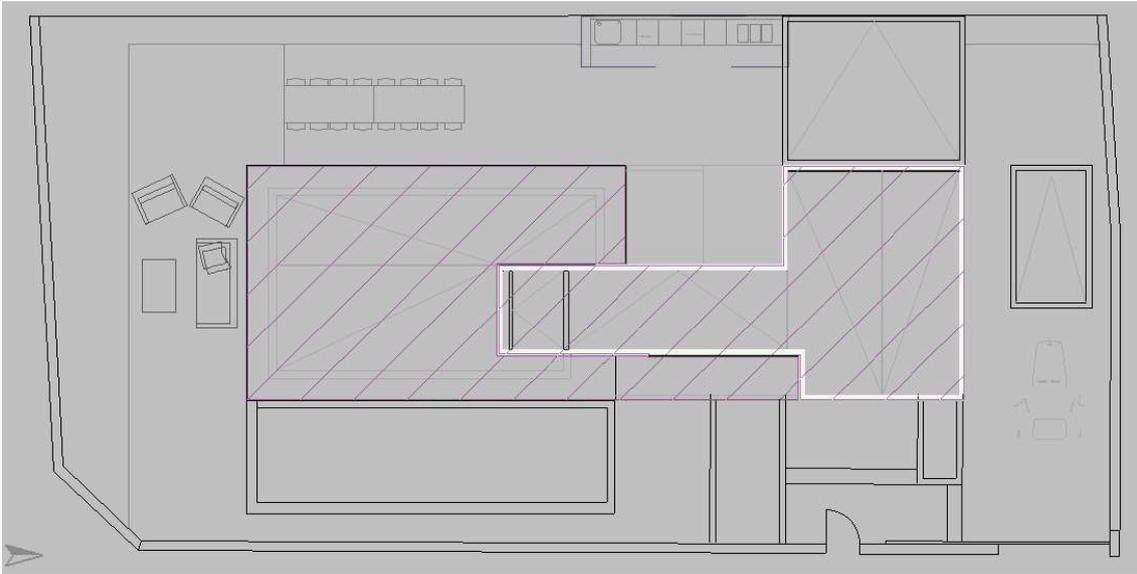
Distribución Planta Cubierta. Vista: En Planta. IFC Builder
